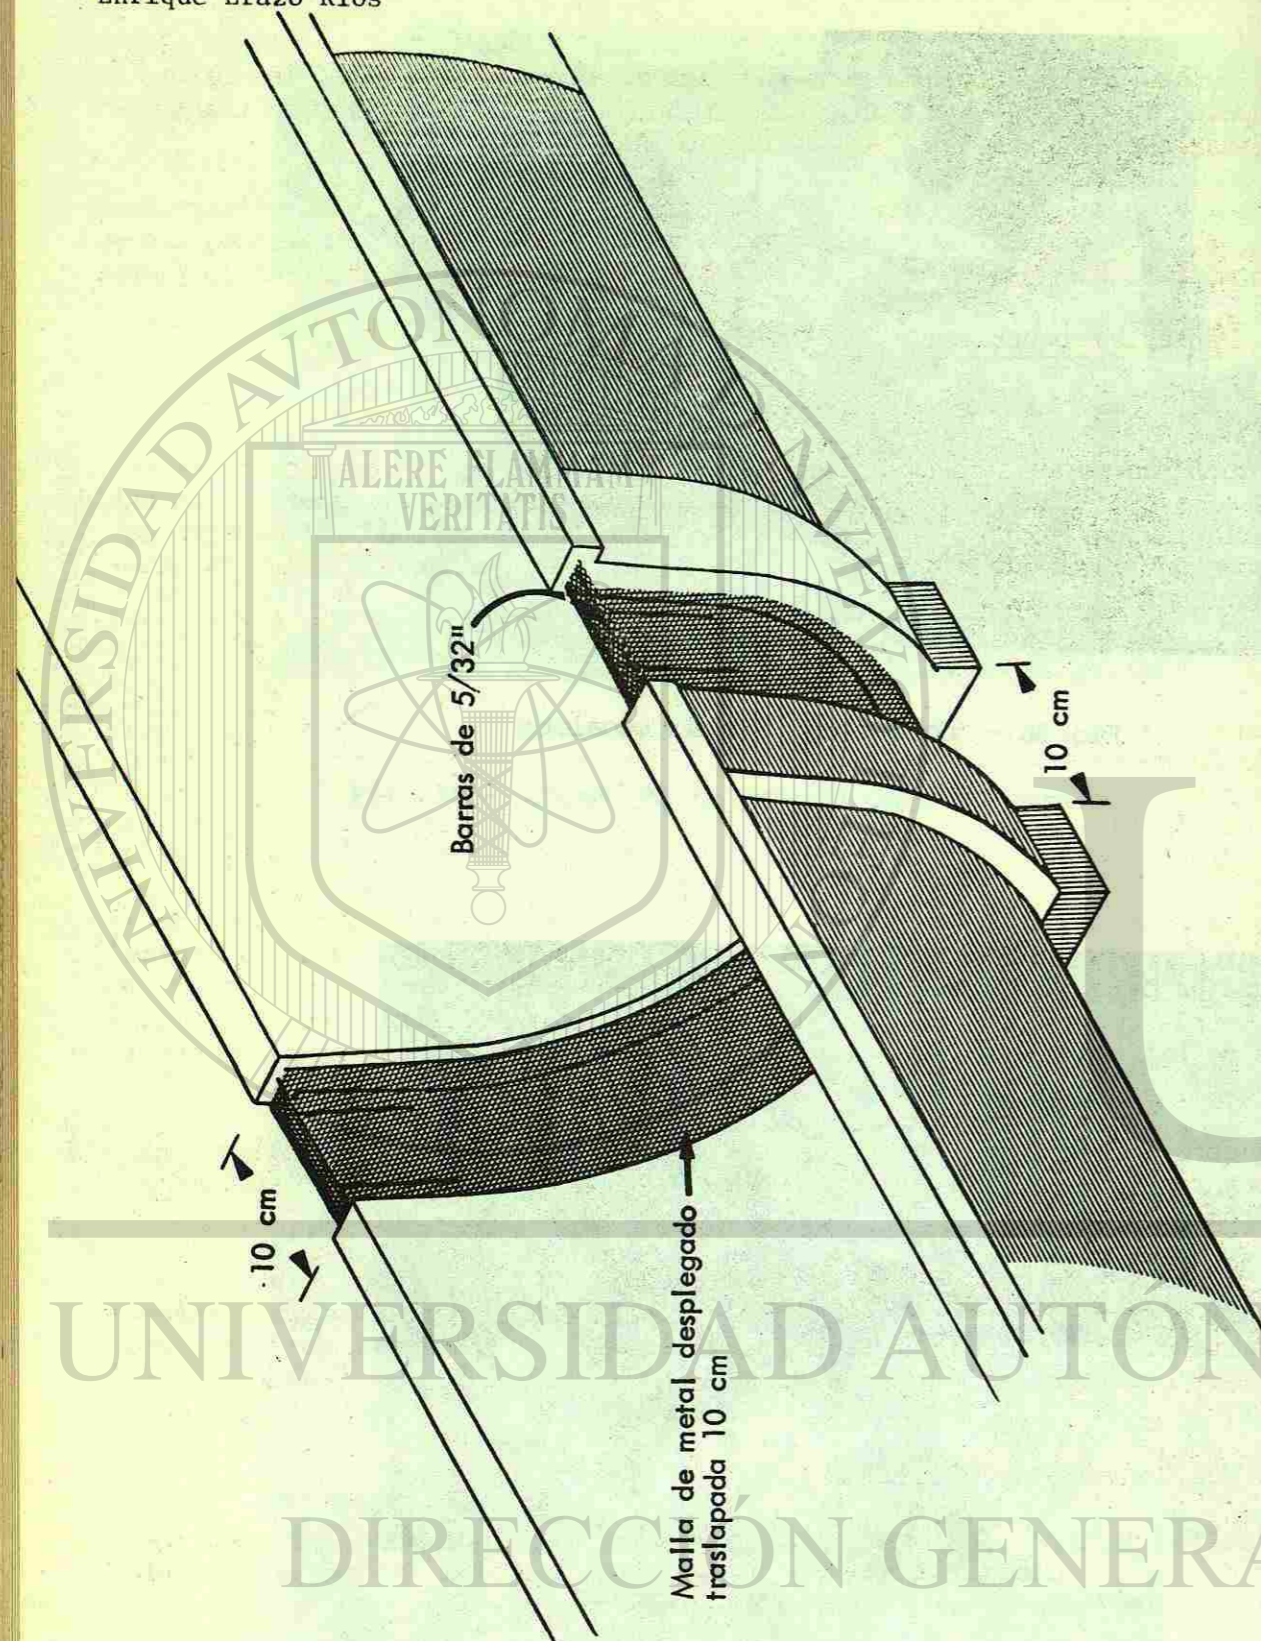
DETALLE DEL ARMADO DE LAS JUNTAS
